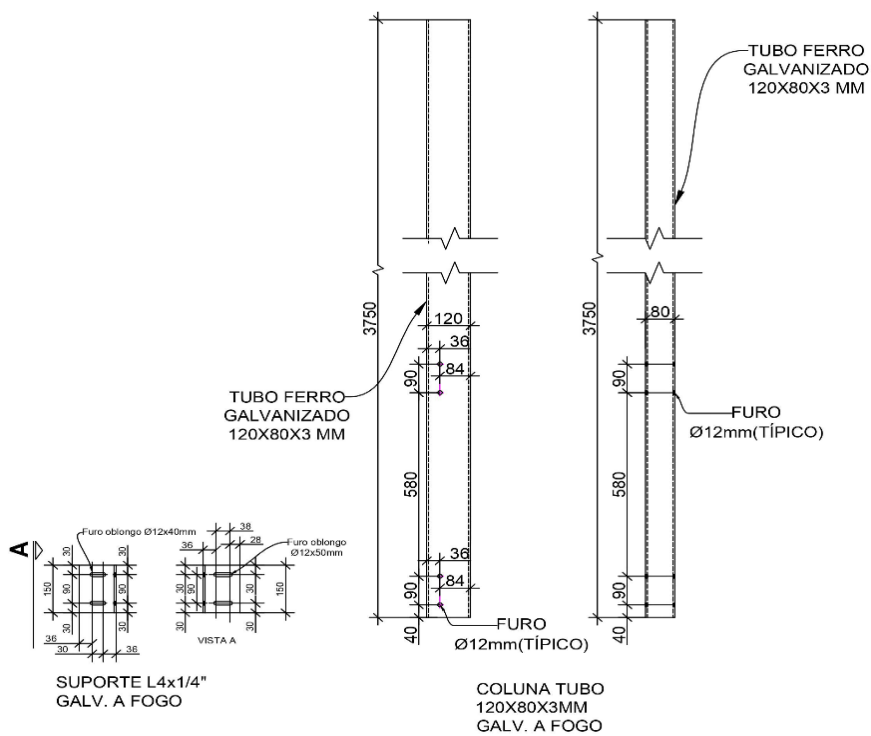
DETALHES CONSTRUTIVOS (medidas em mm)
